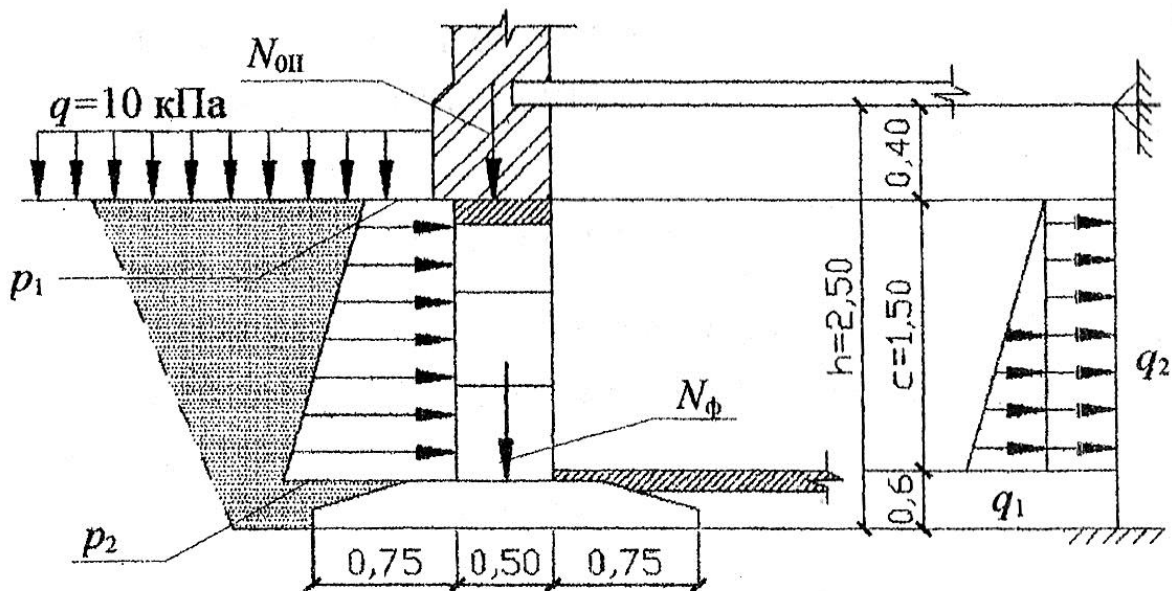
Определение нагрузок на основание ленточного фундамента
